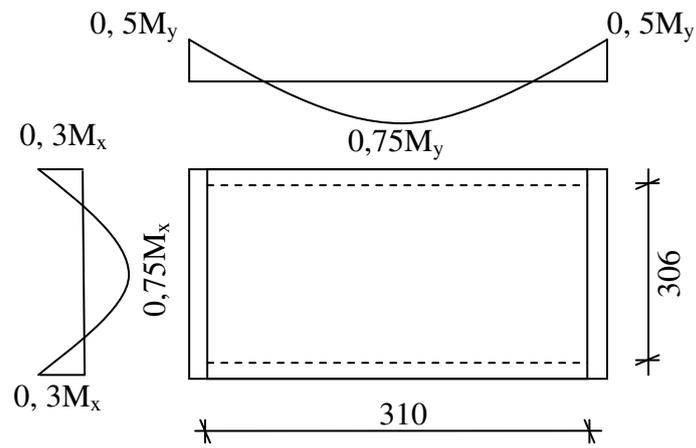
Panneau de dalle appuyé sur 4
